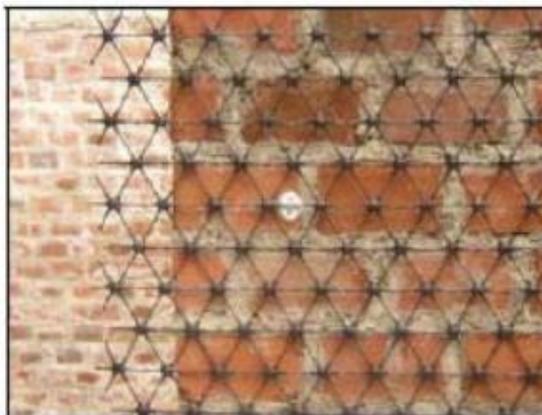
Muro de mampostería reforzada con malla de polímeros
